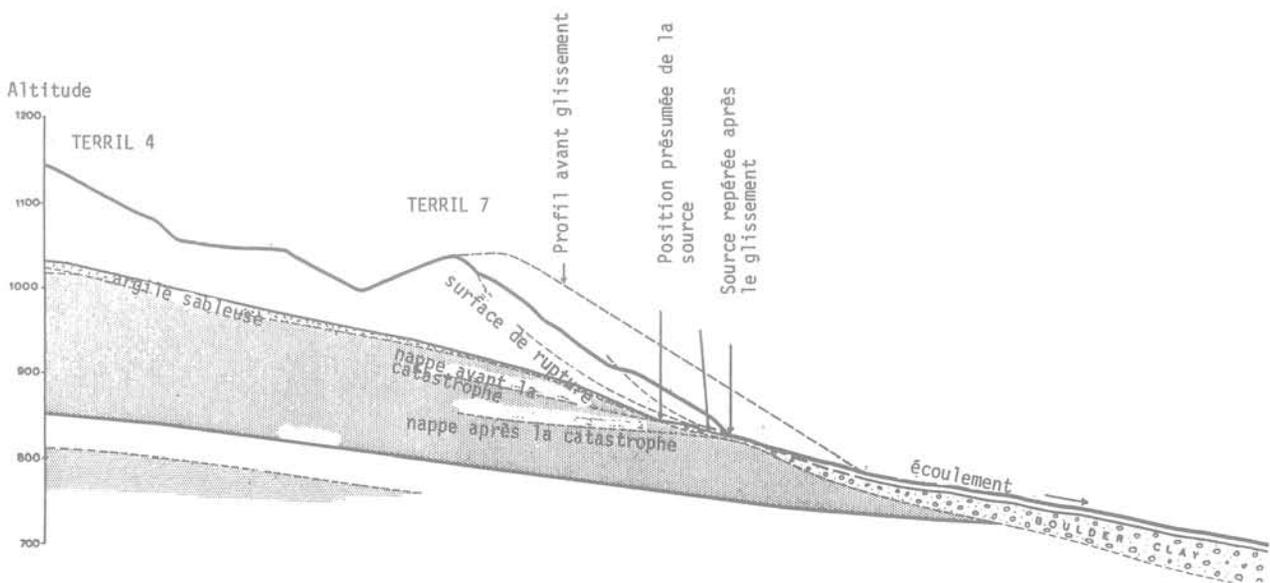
Coupe de la rupture du terril n° 7 d'Aberface (Bishop et al., 1969)
